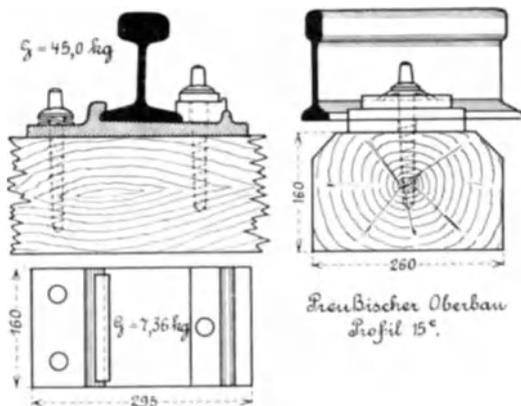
Schwerer Holzschwellen-Oberbau mit Hakenzapfenplatte.
